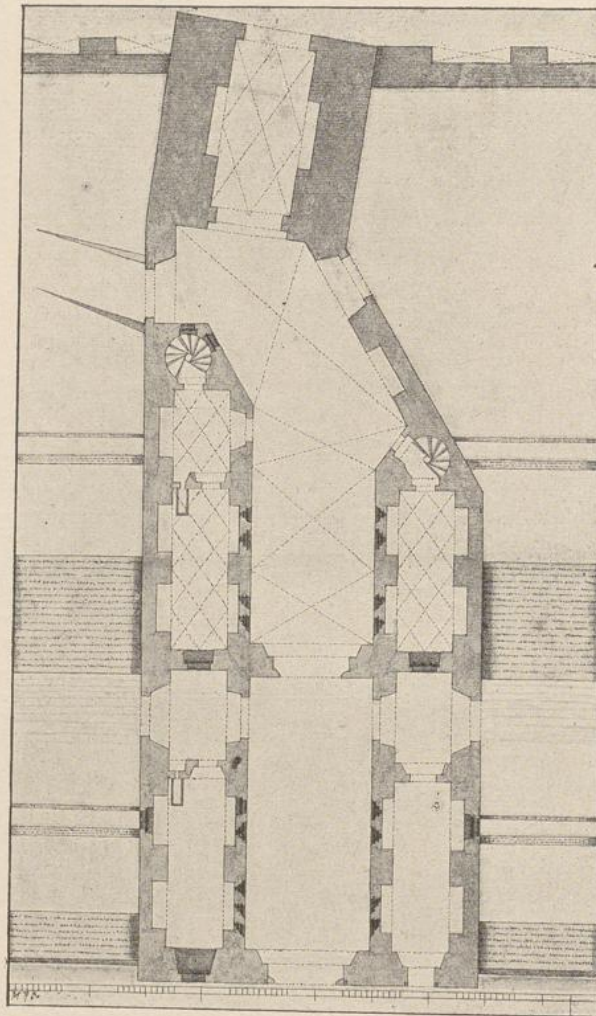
Eschenheimer Thor; Grundriss.
